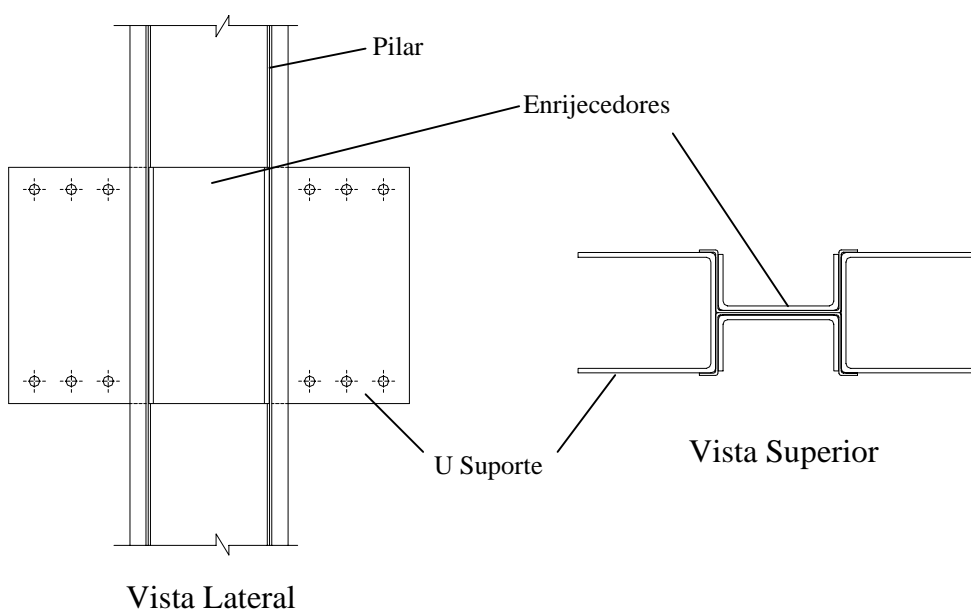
Configuração da ligação proposta para os pilares de extremidade da edificação.
